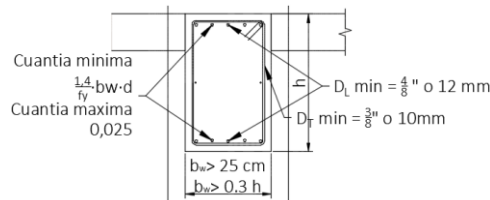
Detalle transversal estructural de VIGA para ductilidad DES
